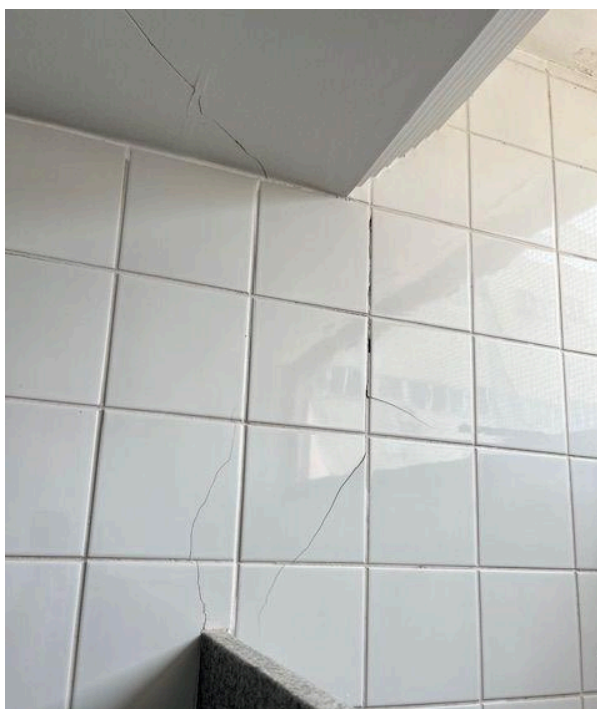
Marcação 2.7 - Trinca vertical na parede próximo ao pilar.
